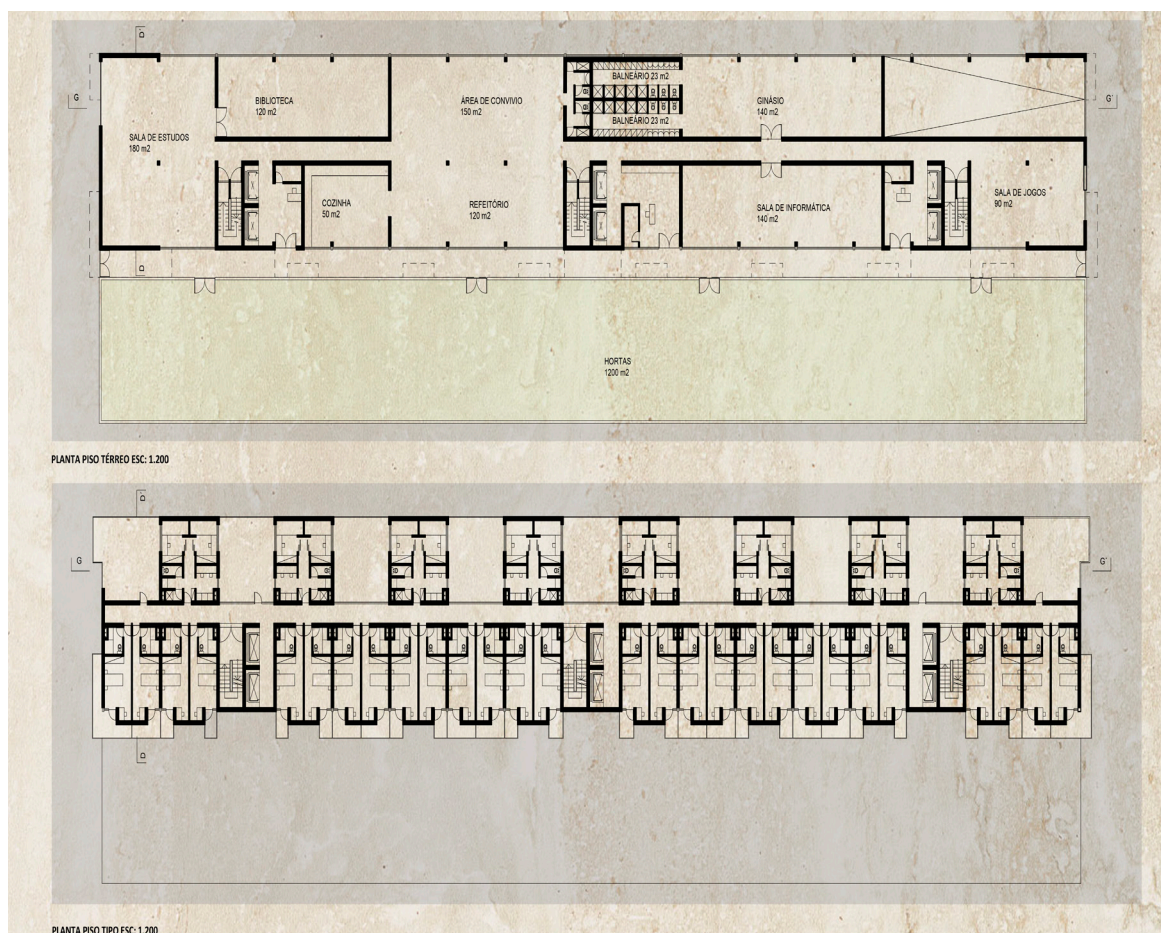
Planta piso térreo / Planta piso tipo, esc: 1.200
